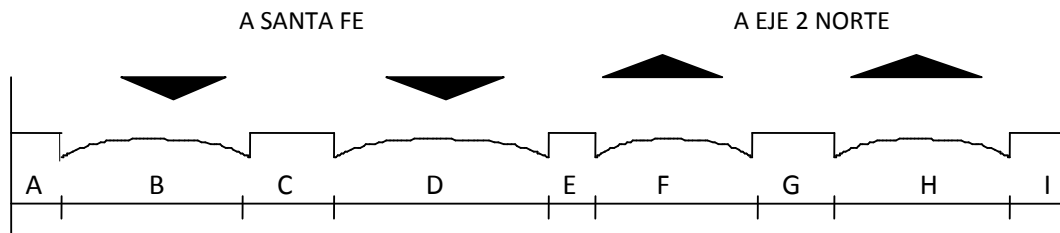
Secciones transversales de la Avenida Paseo de la Reforma.
